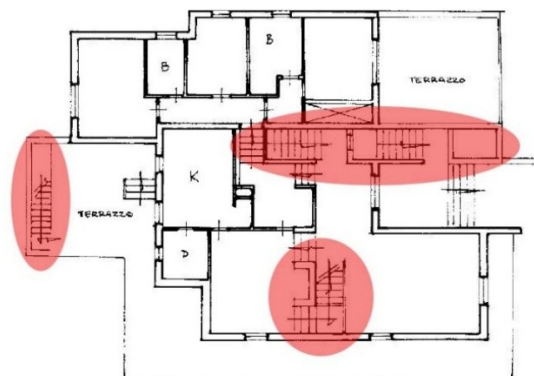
Stralcio plan. Catastale subalterno 4
